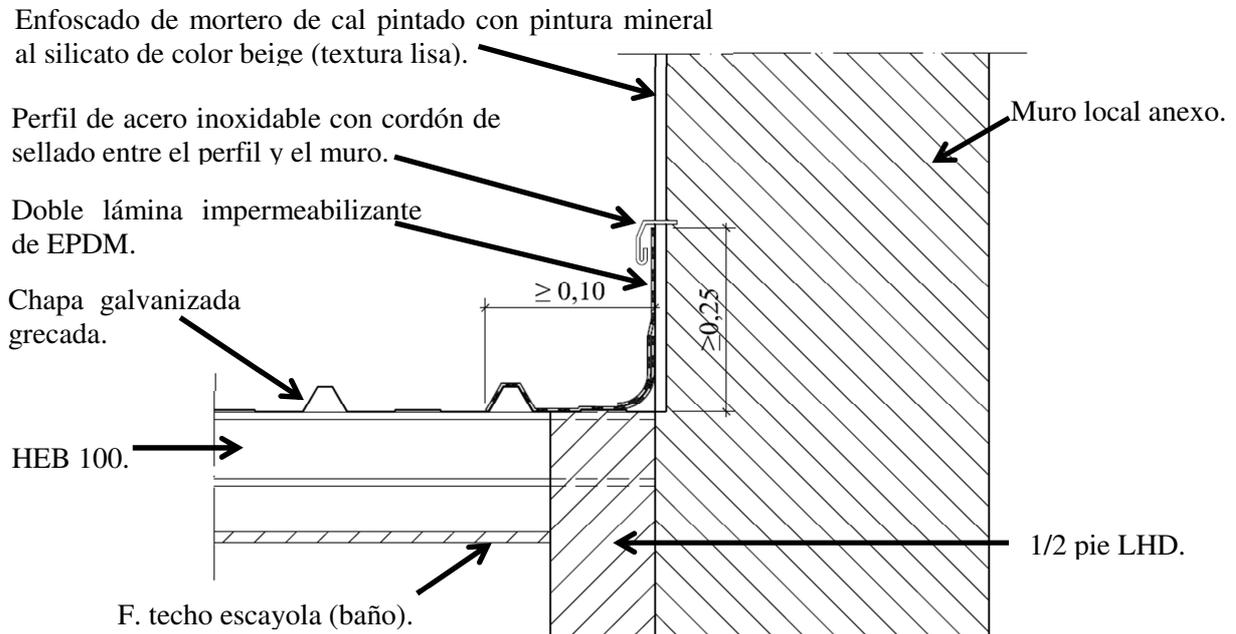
Encuentro de la chapa galvanizada grecada con el paramento vertical. Impermeabilización.
